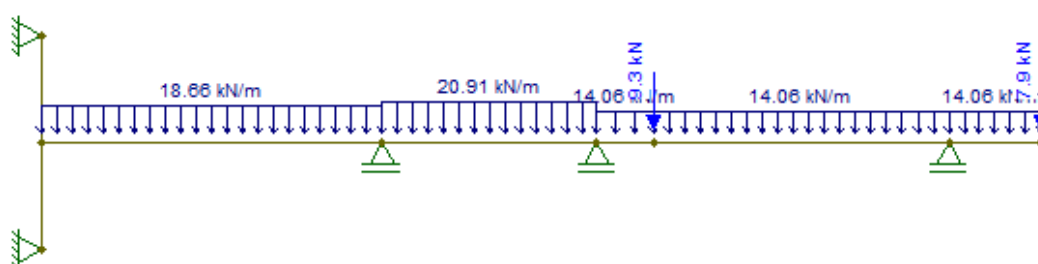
CARREGAMENTOS DE CÁLCULO NO ELU VIGA 43
